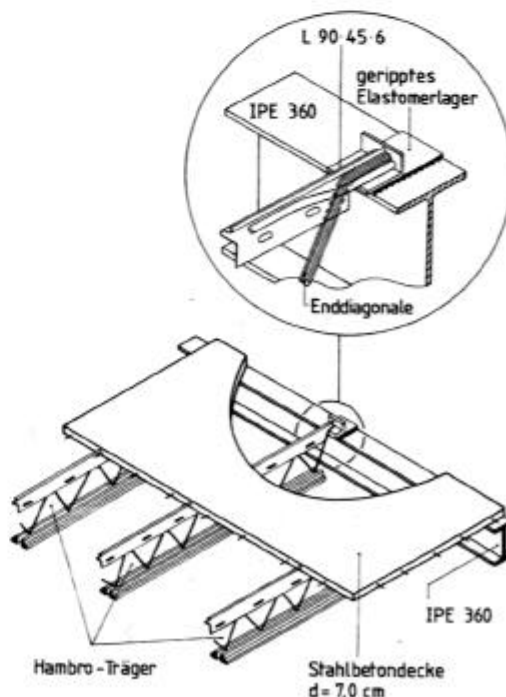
„HAMBRO“-Träger mit Auflagerdetail
